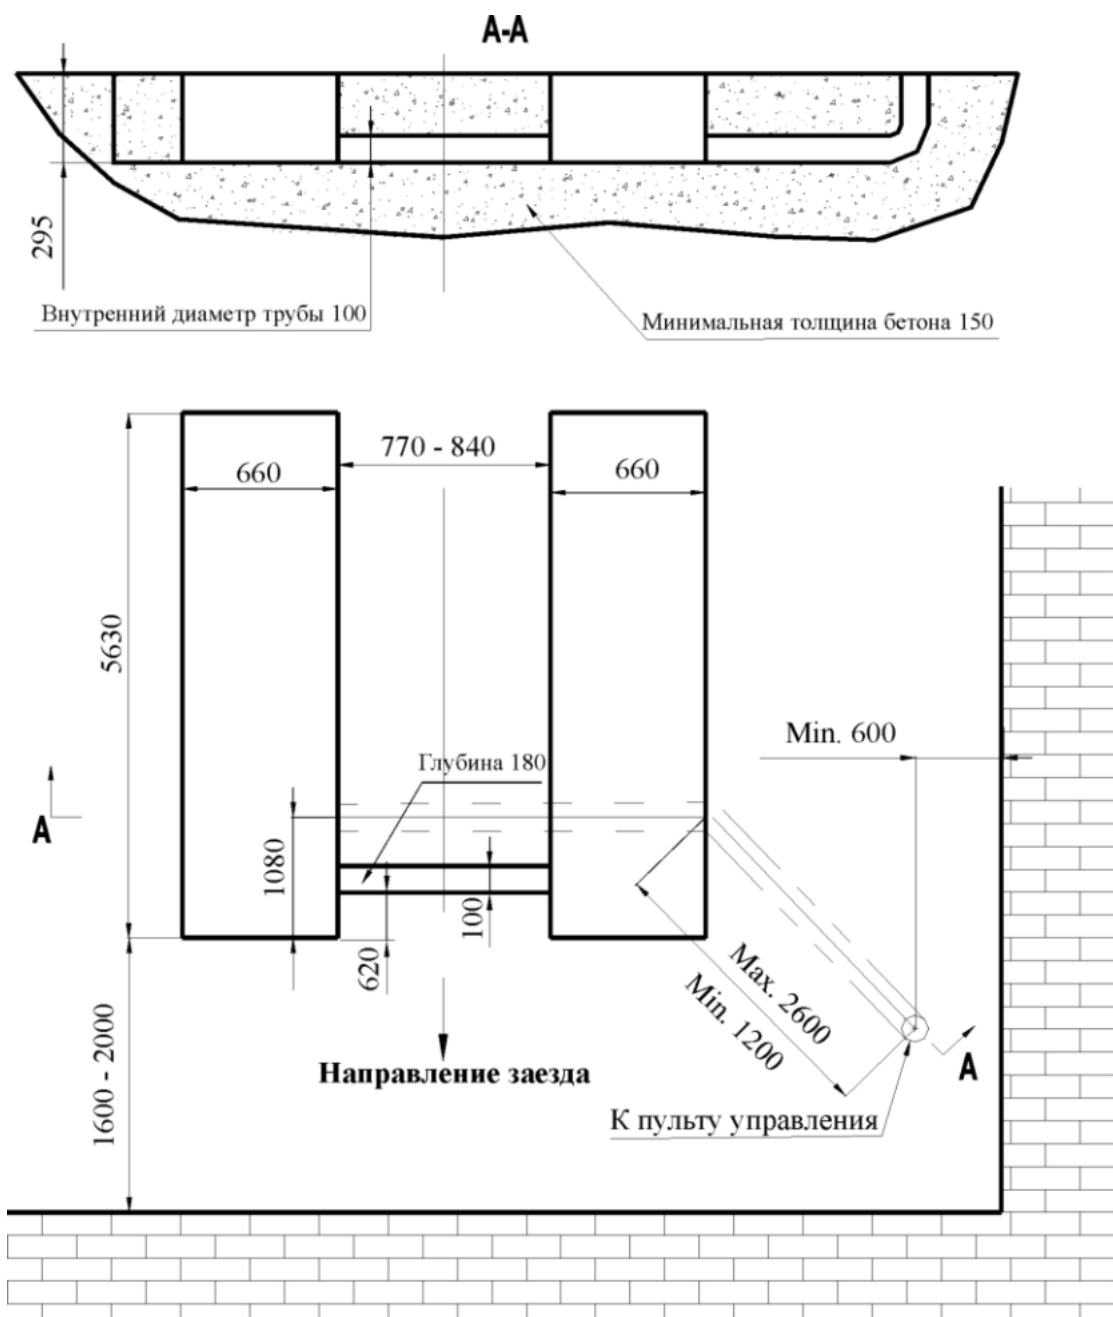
Схема подготовки фундамента (только для монтажа в пол)
